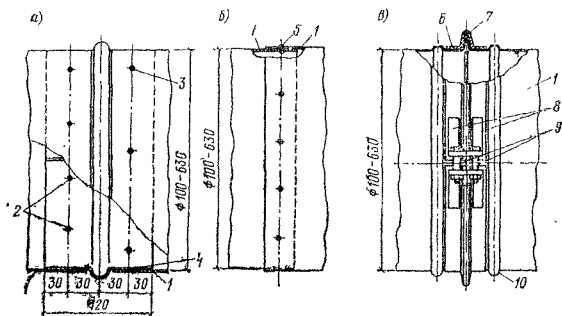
Типы бесфланцевых соединений круглых воздуховодов
